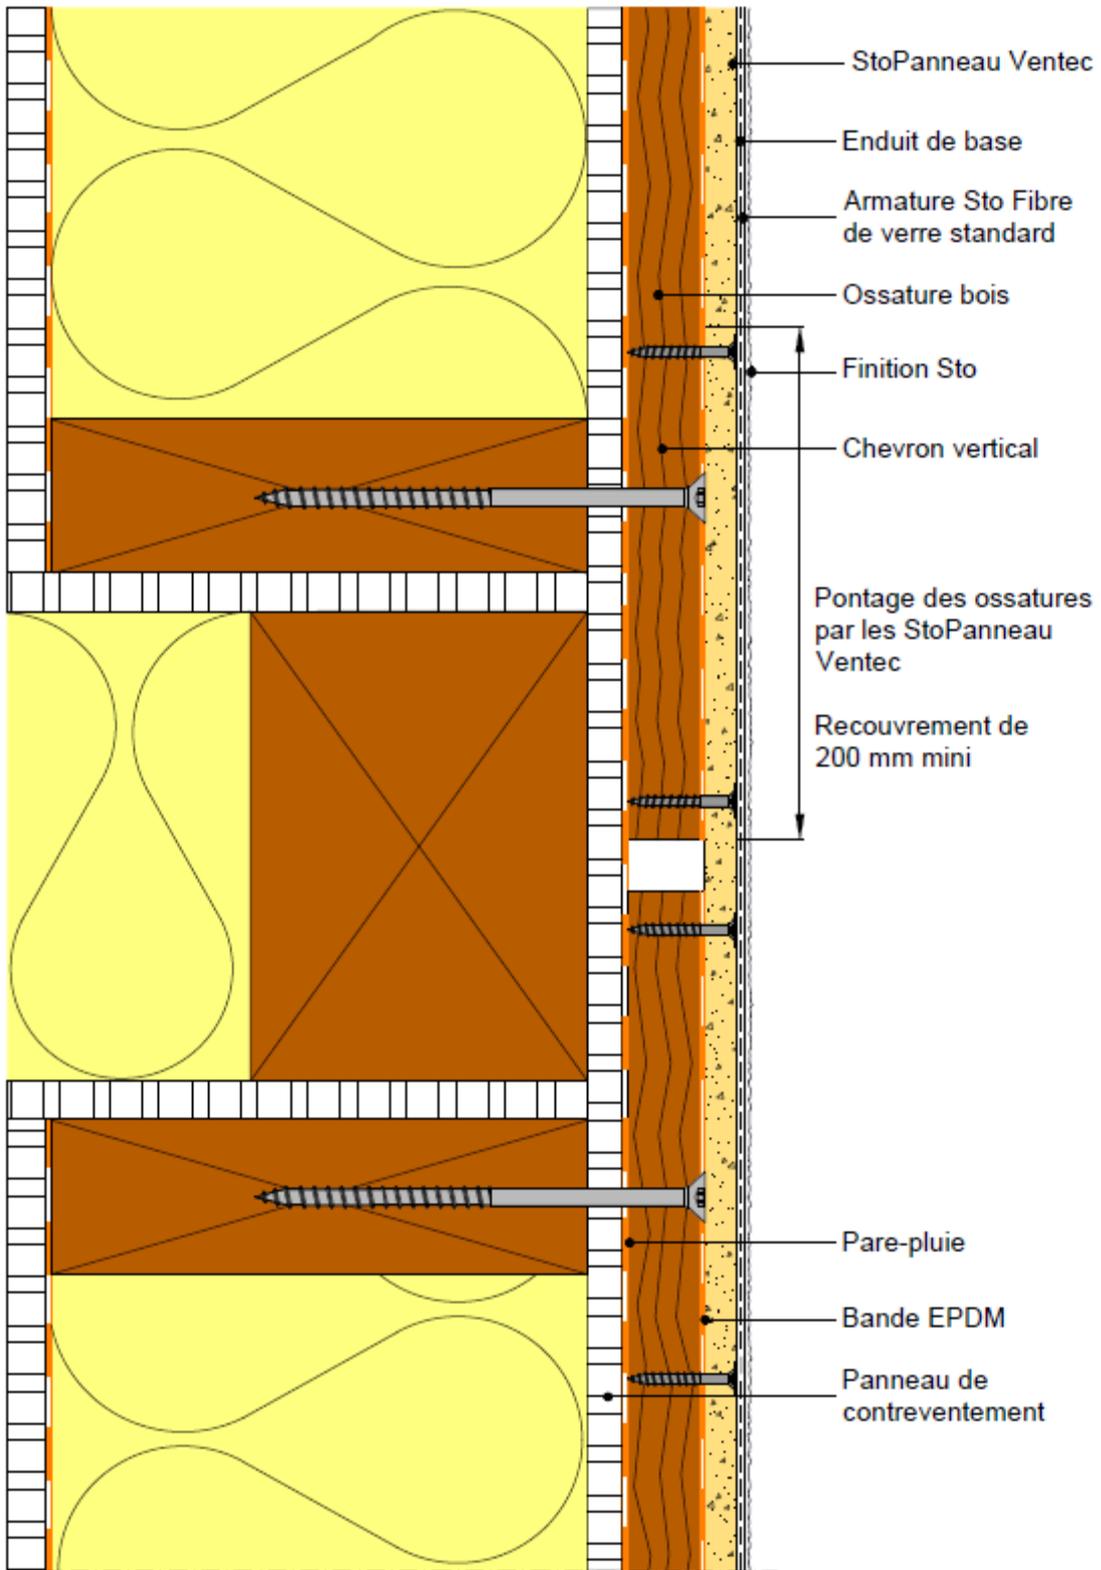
Coupe verticale - Fractionnement des ossatures au droit d'un plancher- Ossatures bois sur COB
